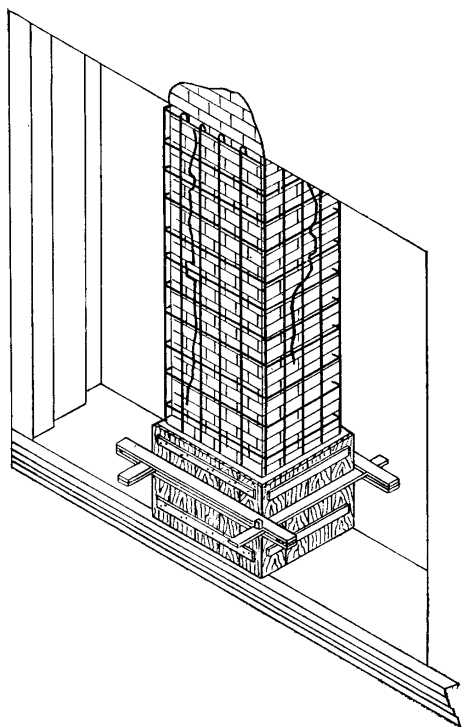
Установка опалубки при усилении простенка железобетонной обоймой
